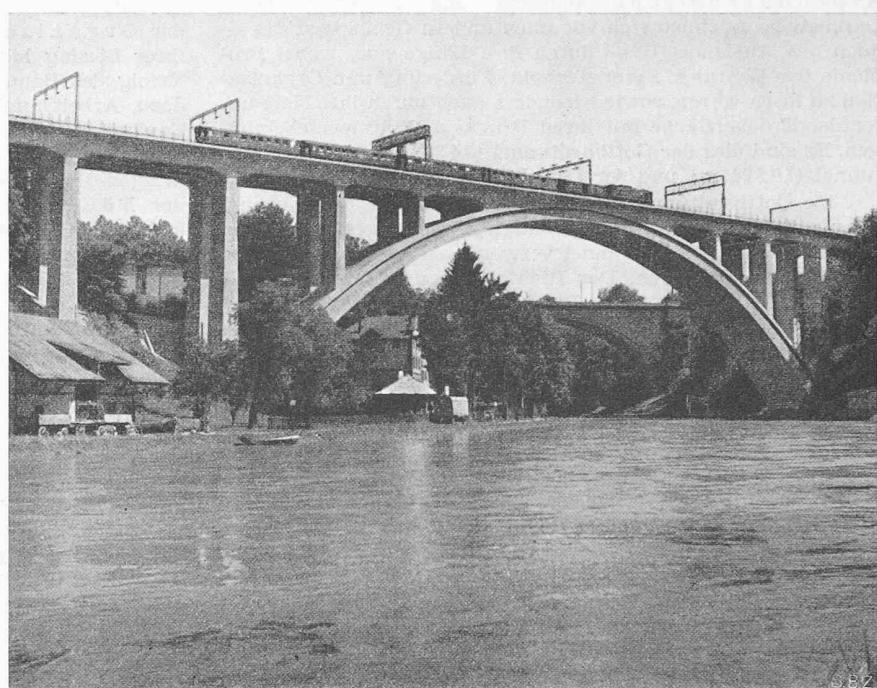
Eisenbetonbrücke für vier Gleise, erbaut 1938/40 als Ersatz der Brücke Bild 9.
